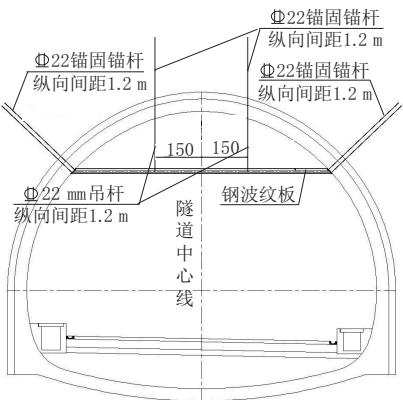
送风口钢波纹板顶隔板断面布置图(单位:cm)
